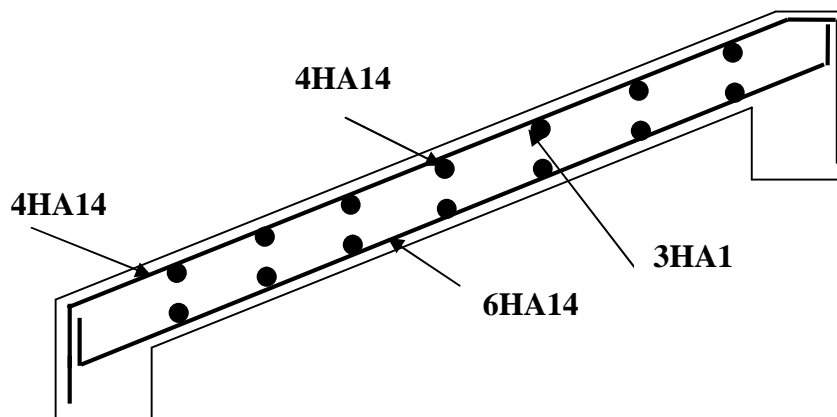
Schéma de ferrailage de l'escalier type IV
